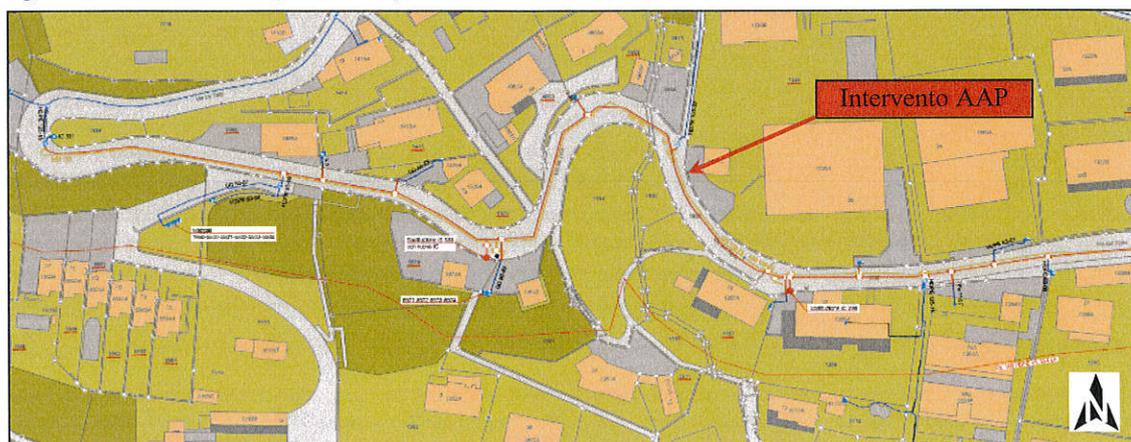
Planimetria d'intervento (tratta Ovest) – lotto 5.
